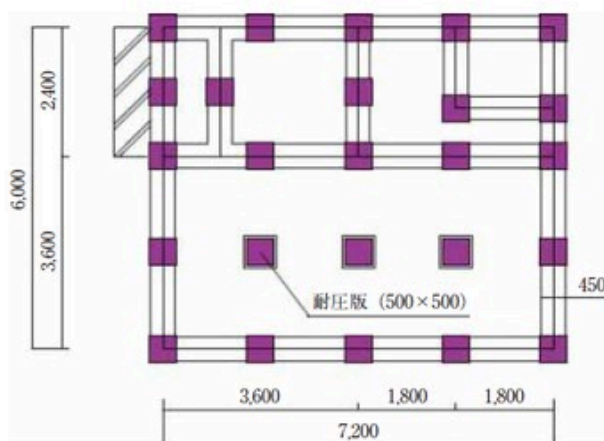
耐圧版工法の耐圧版配置例 (単位: mm)
